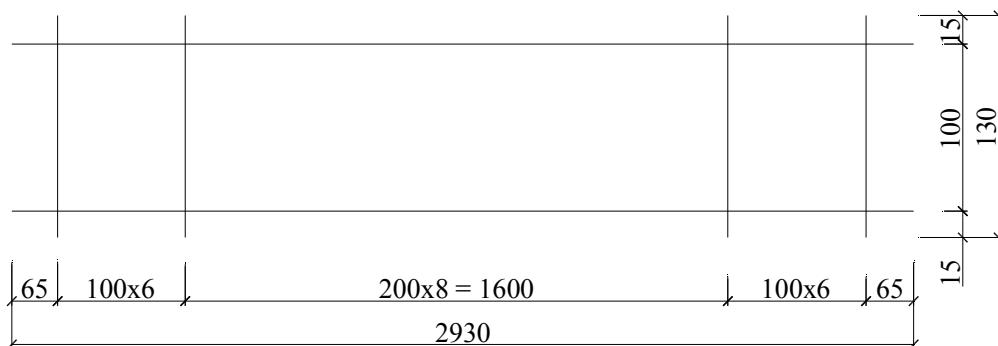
Плоскі арматурні каркаси поперечних ребер
